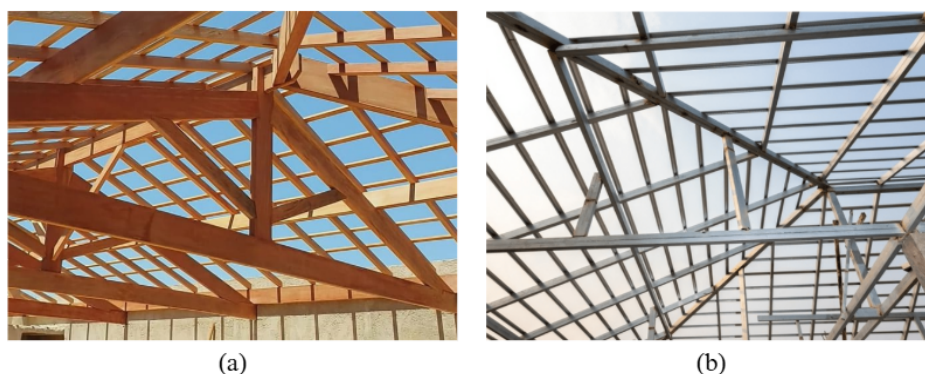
Tipos de estrutura de telhado: (a) estrutura de madeira e (b) estrutura metálica. (Adaptado de [20,21]).
